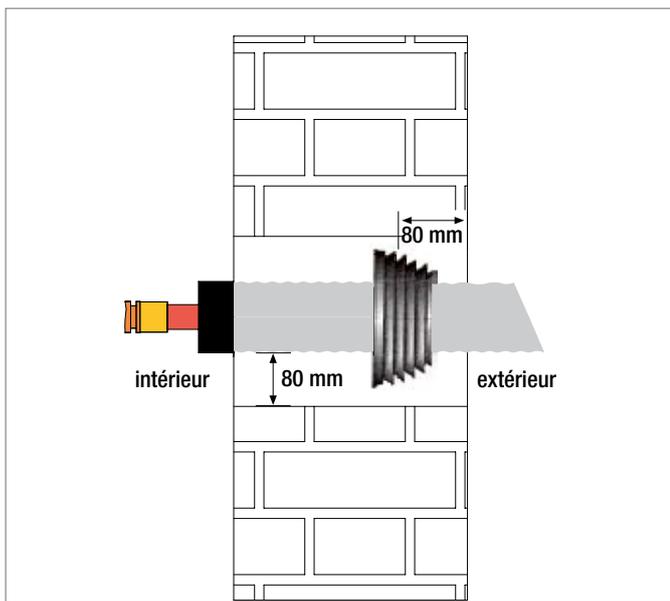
, Joint d'étanchéité mural dentelé Vue latérale, perçage du mur
